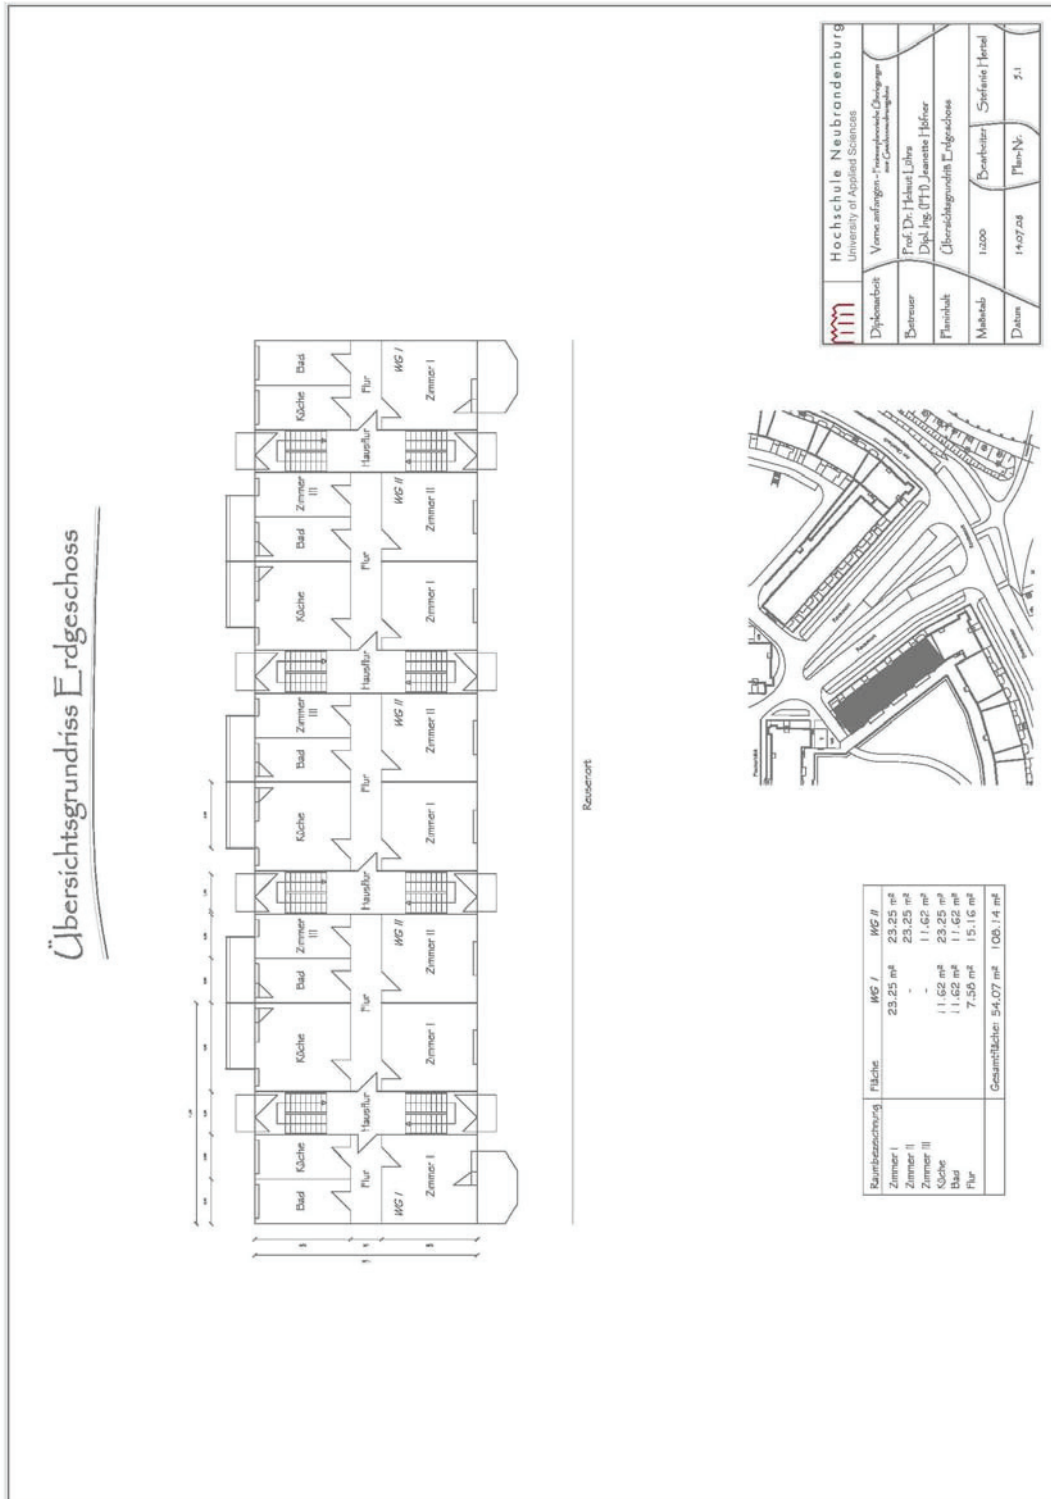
Übersichtsgrundriss des Erdgeschosses
